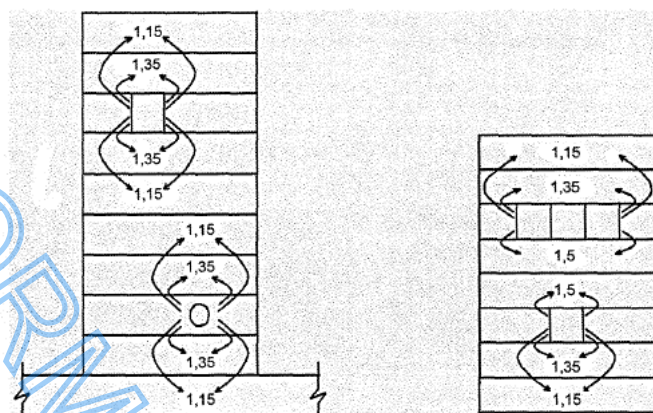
Схема переноса нагрузок от панелей с большими отверстиями
